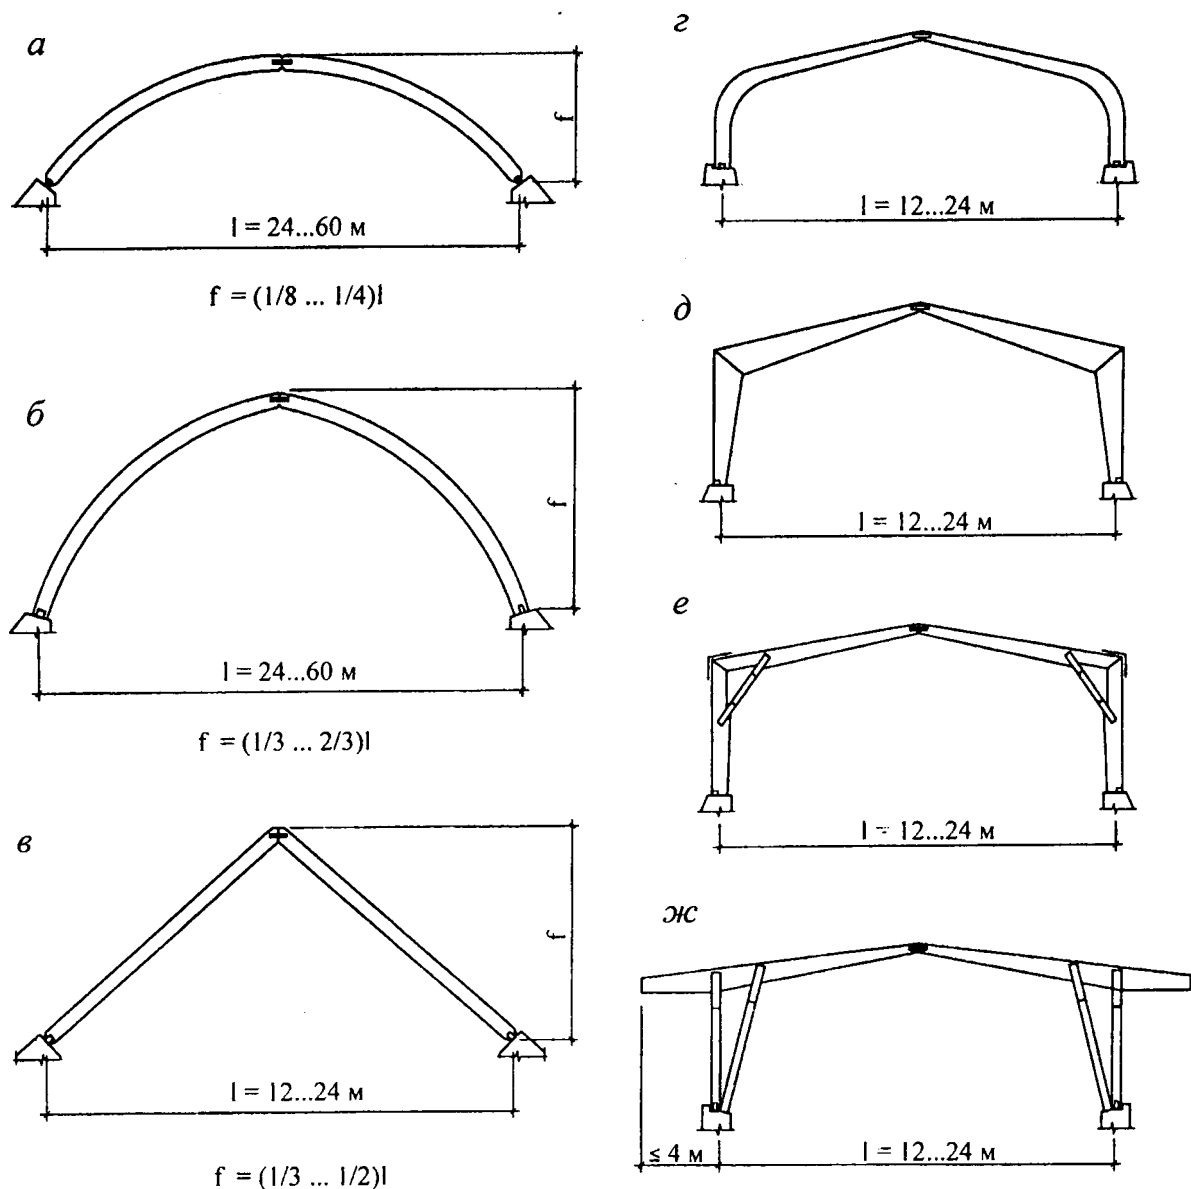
Схемы трехшарнирных распорных конструкций:
